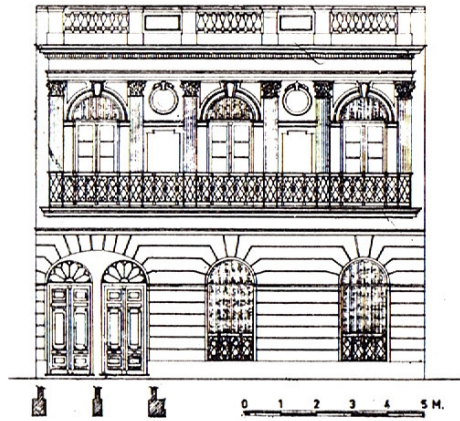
Casa "Standard" de 2 plantas — Fachada.
